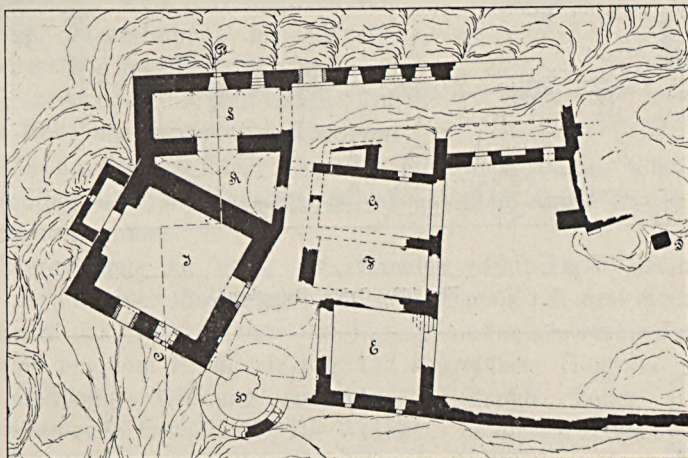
Oybin, Westbau, Grundriß des Untergeschosses.
